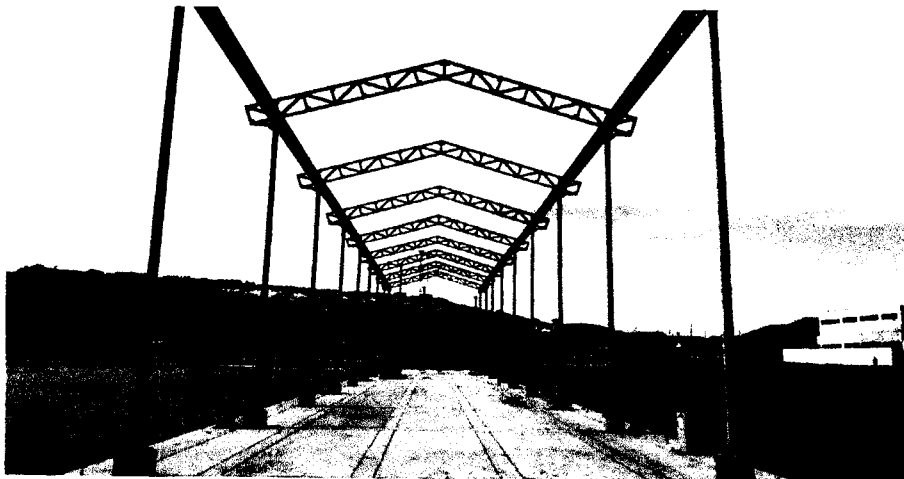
Tijerales y vigas soldadas en columnas metálicas
